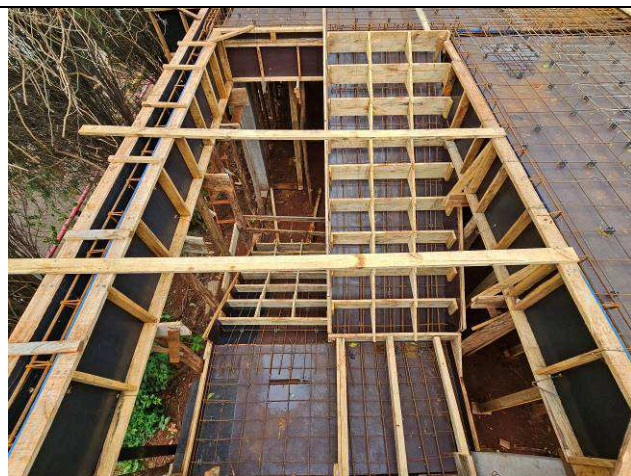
Formas e armaduras – vigas e lajes – 1º Pavimento.
